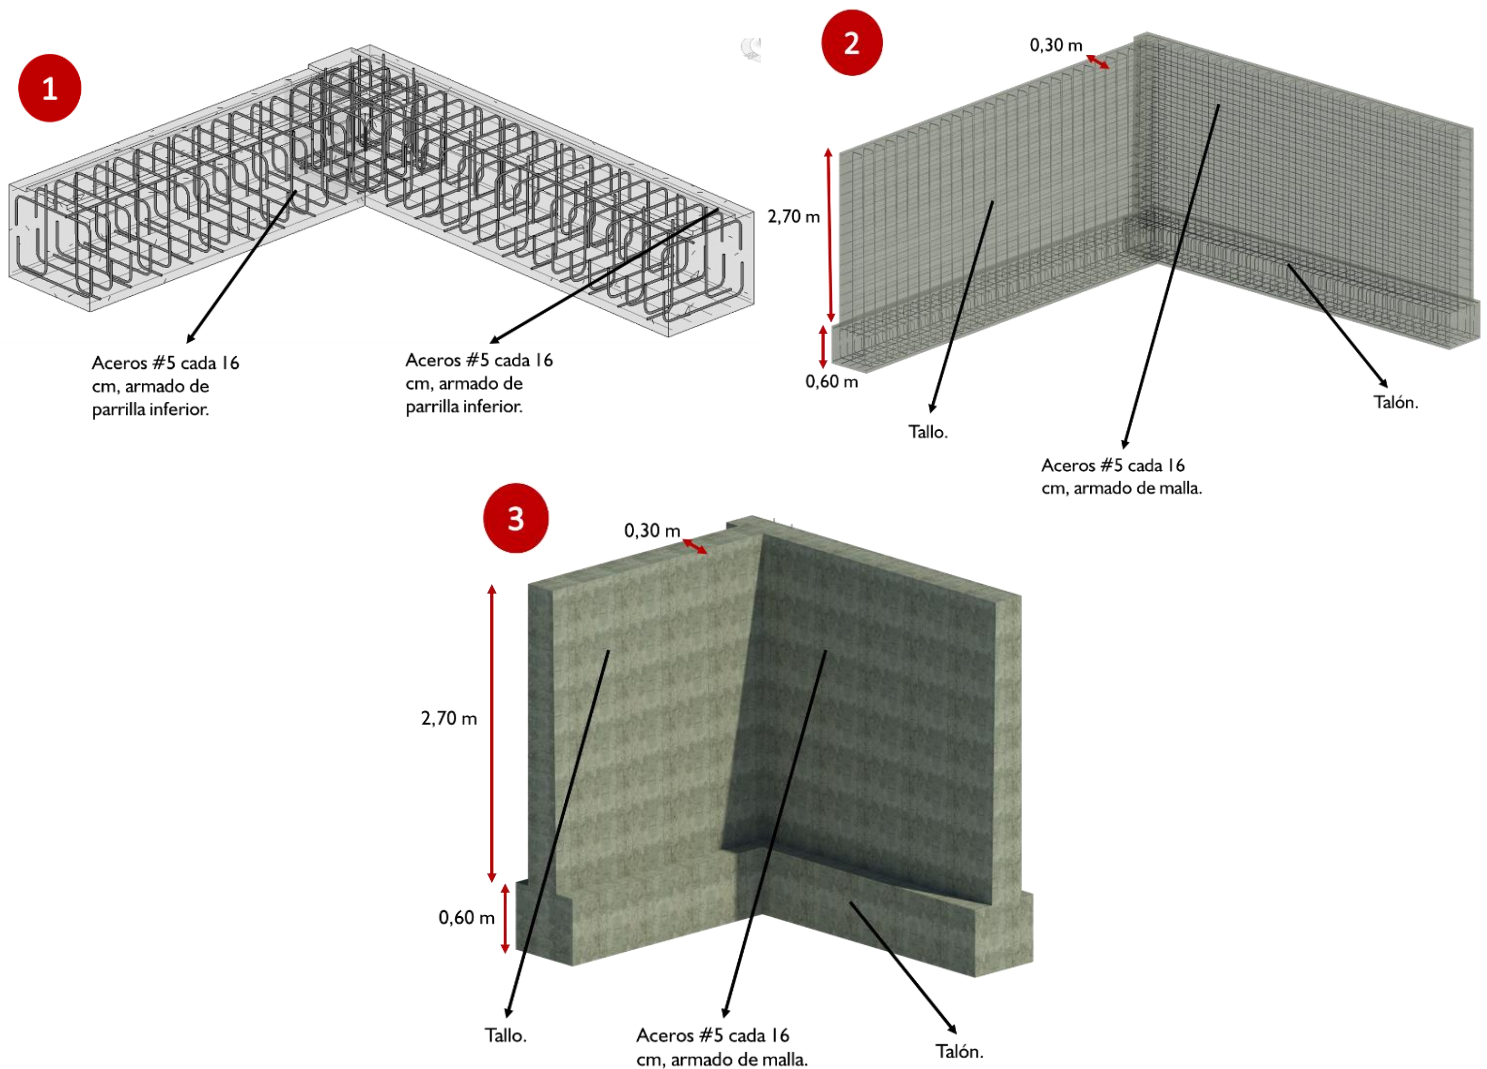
Detalle constructivo muro de contención: Tomado de: *autoría propia
